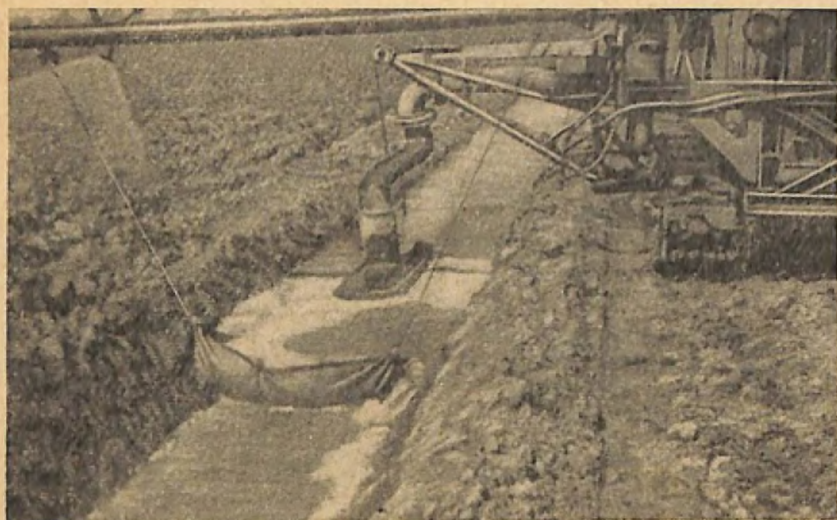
Брезентовая перемычка прямоугольного сечения на оросителе (вид с нижнего бьефа)
